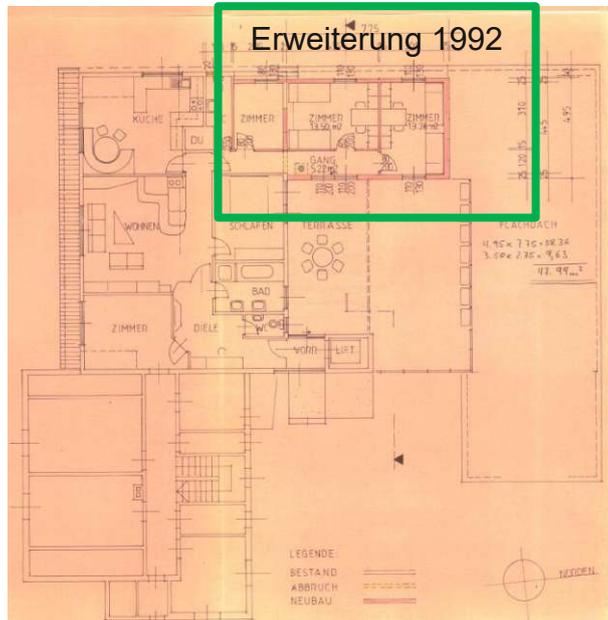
Grundriss 2.OG, Zubau Geschäftstrakt – Einreichplanung August 1992 (eigene Aufnahme)
